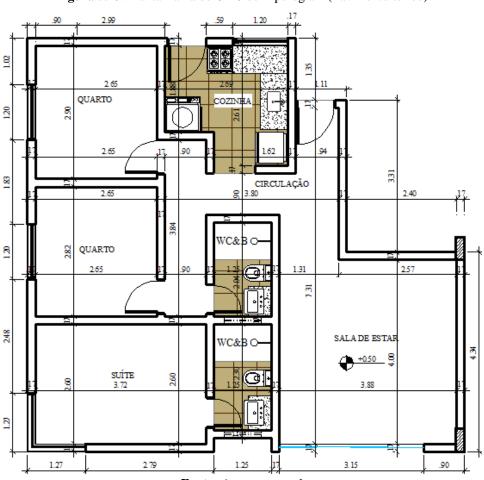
Planta Baixa de UHC de Tipologia 1 (Pavimento térreo)
